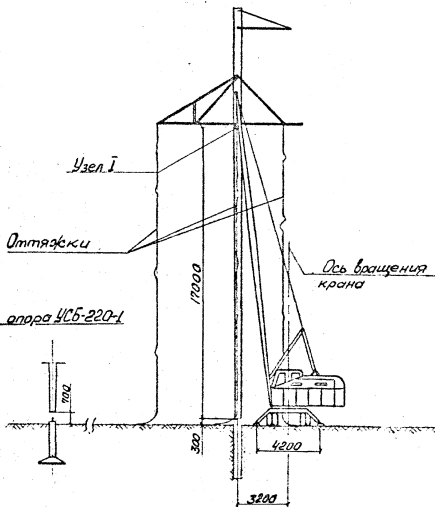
Схема подъема анкерно-целовых железобетонных опор краном К-5363
